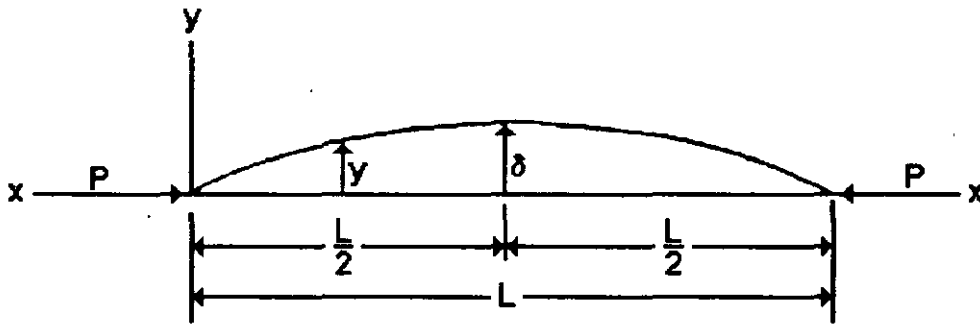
PERFIL PANDEADO DE UNA COLUMNA CON EXTREMOS ARTICULADOS
